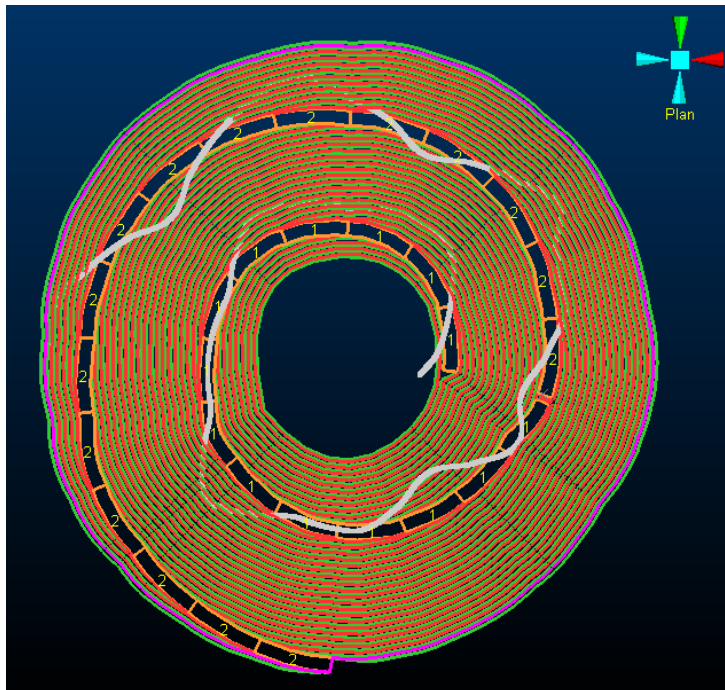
Vista planta ajuste pit suavizado y línea de puntos.
